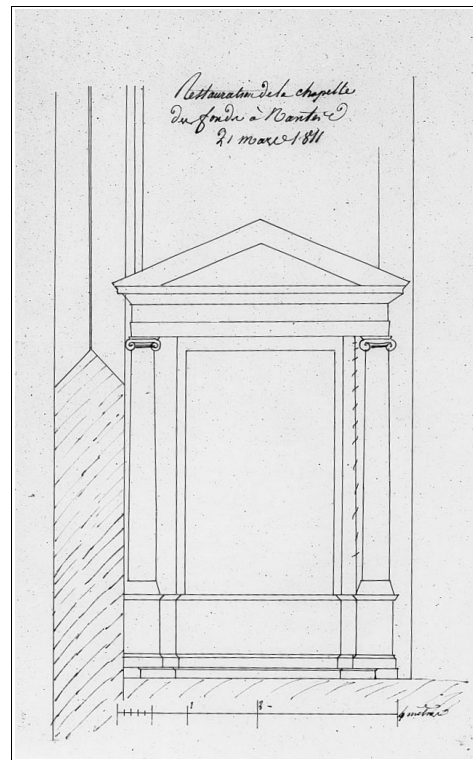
Restauration de la chapelle des fonts de la cathédrale : croquis de l'élévation, 1811 (AN F 19²¹ 1888, jaquette 1631 ; ARCHIM B-001891)
